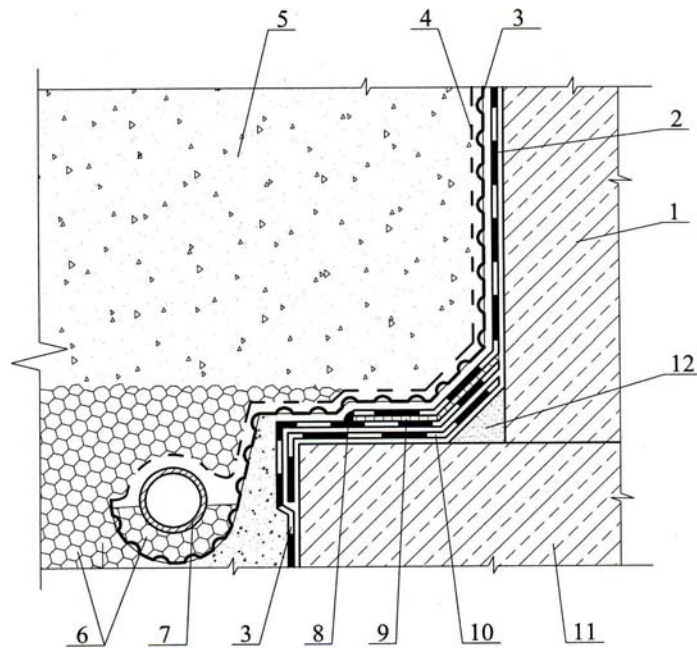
Гидроизоляция тоннеля при наличии грунтовых вод
